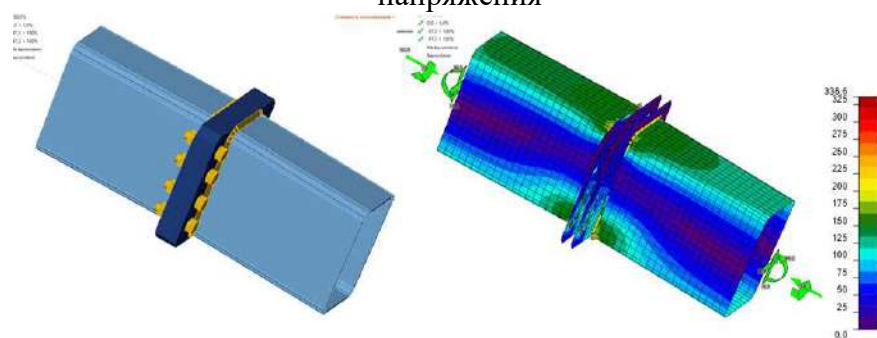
Узел сборки несущего ребра: 3D-модель, эквивалентные напряжения
